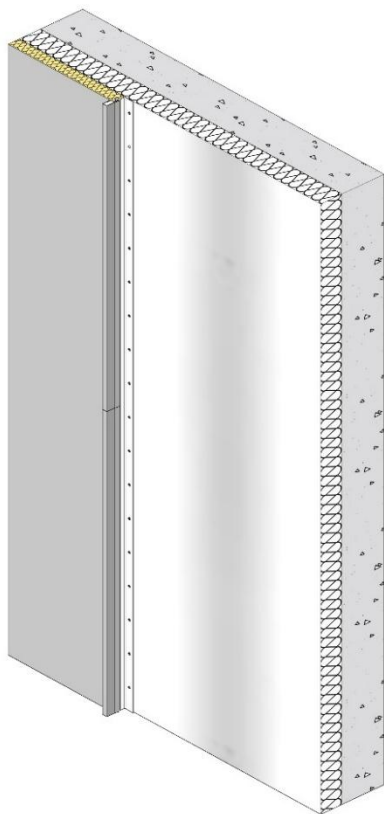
Principe d'emboîtement du profil joint debout MYRAL
